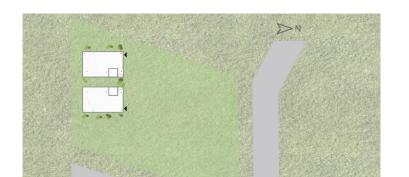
Plantas baixas - entorno - Casa Cambará Container.
